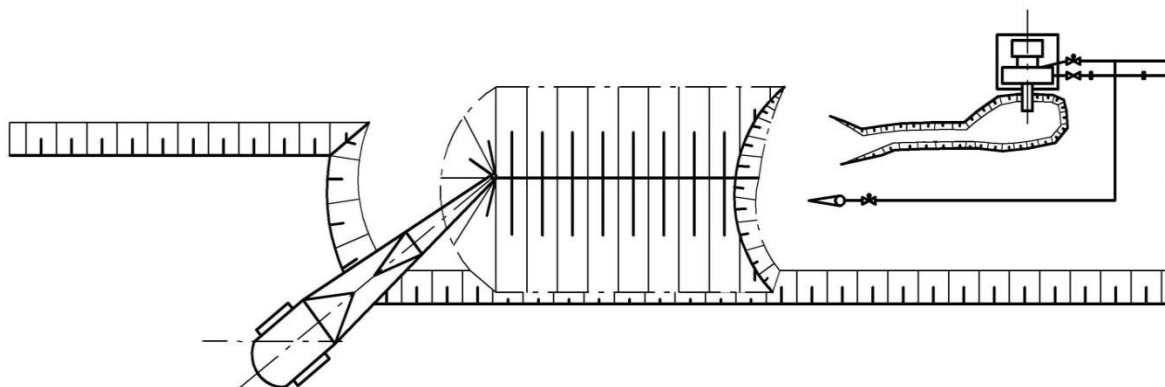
Предварительное рыхление пород экскаватором с укладкой её в навал, расположенный на нижней площадке уступа
